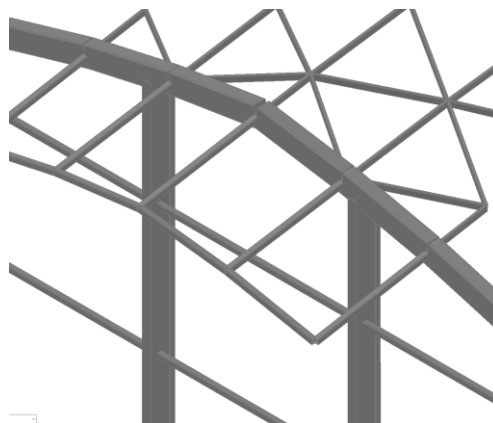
Detalle de las barras de la fachada con inclinación.
